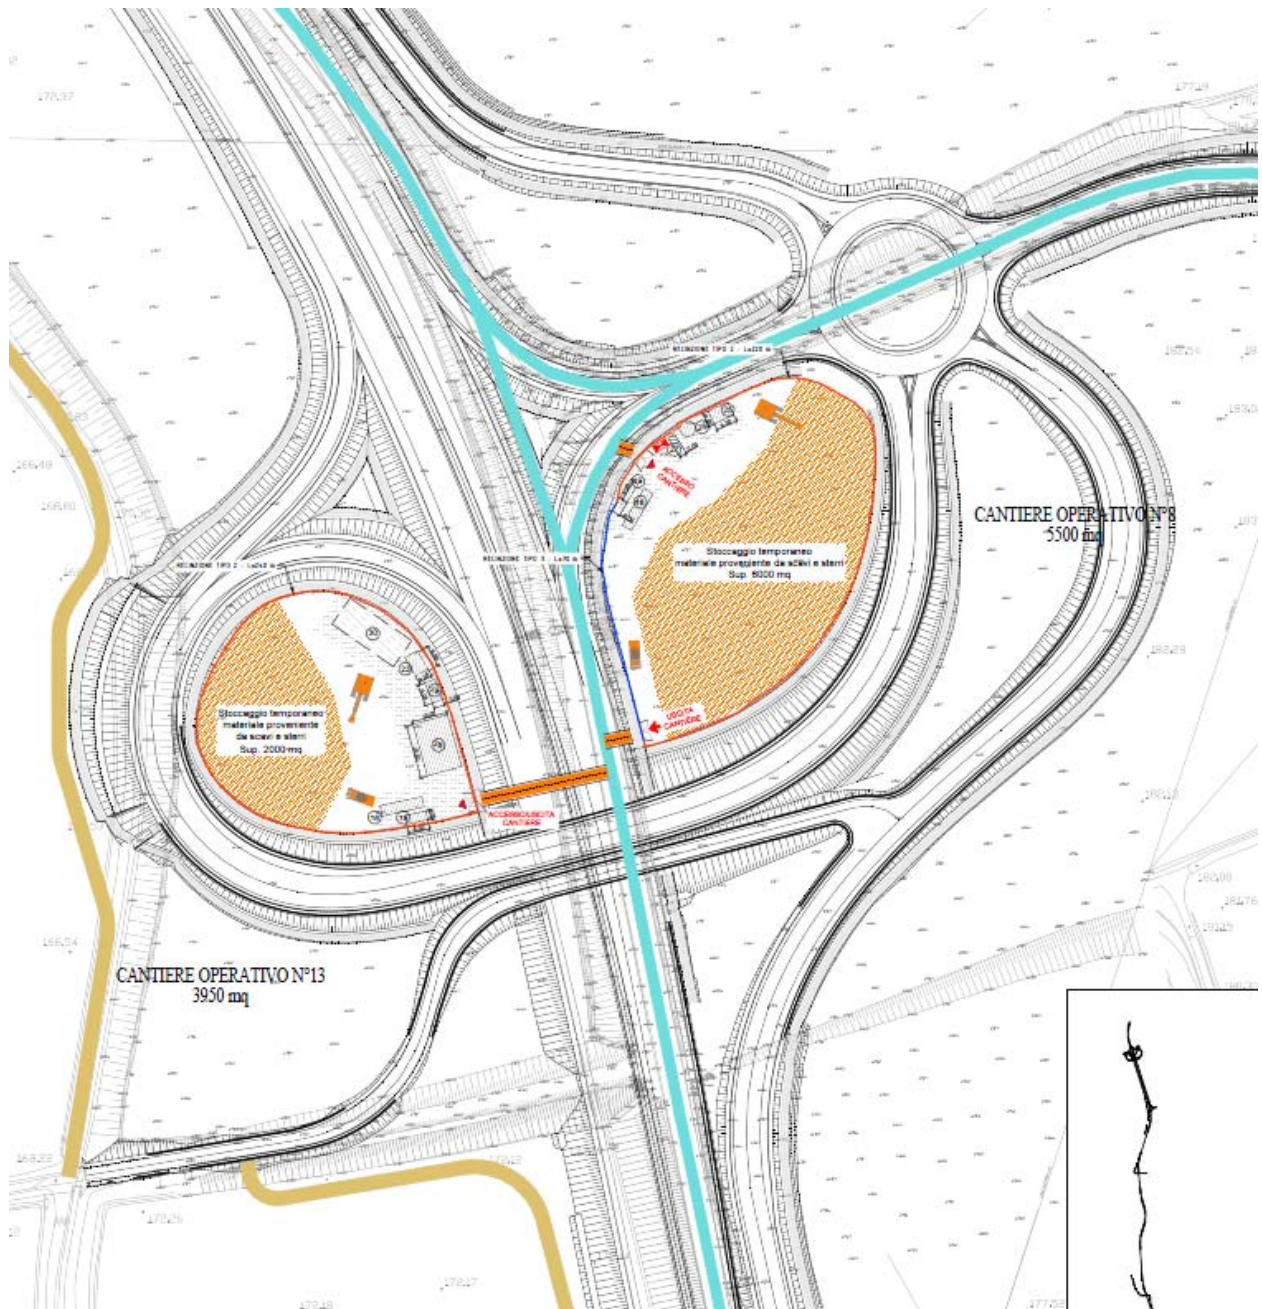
Planimetria cantiere operativo 8 e cantiere operativo 13.
